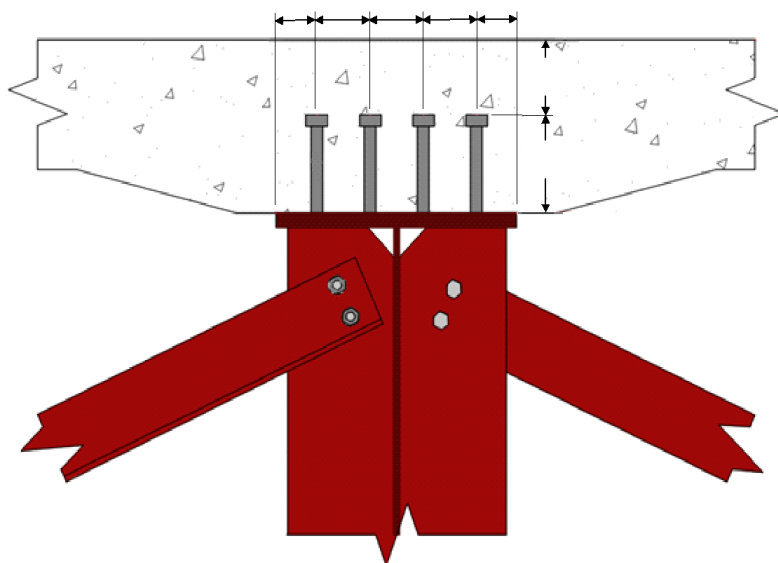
Vista em corte transversal dos conectores de cisalhamento (unidade em milímetros) do tipo pino com cabeça – Projeto II [Adaptado de Pinho & Bellei (2020)].
